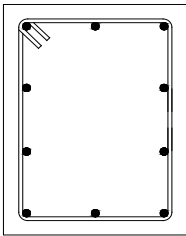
Denah Tinjauan Kolom Lantai 4 s/d Lantai 11
